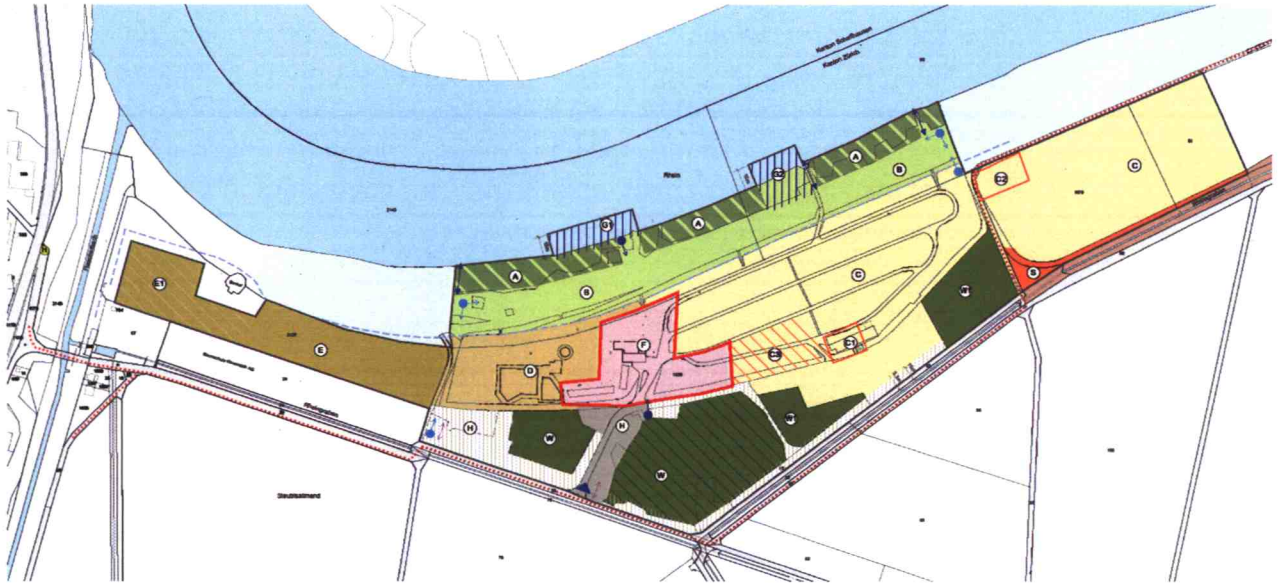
Situationsplan (Originalmassstab 1:1000) zum Gestaltungsplan "Steubisallmend" (Quelle: HSP)
